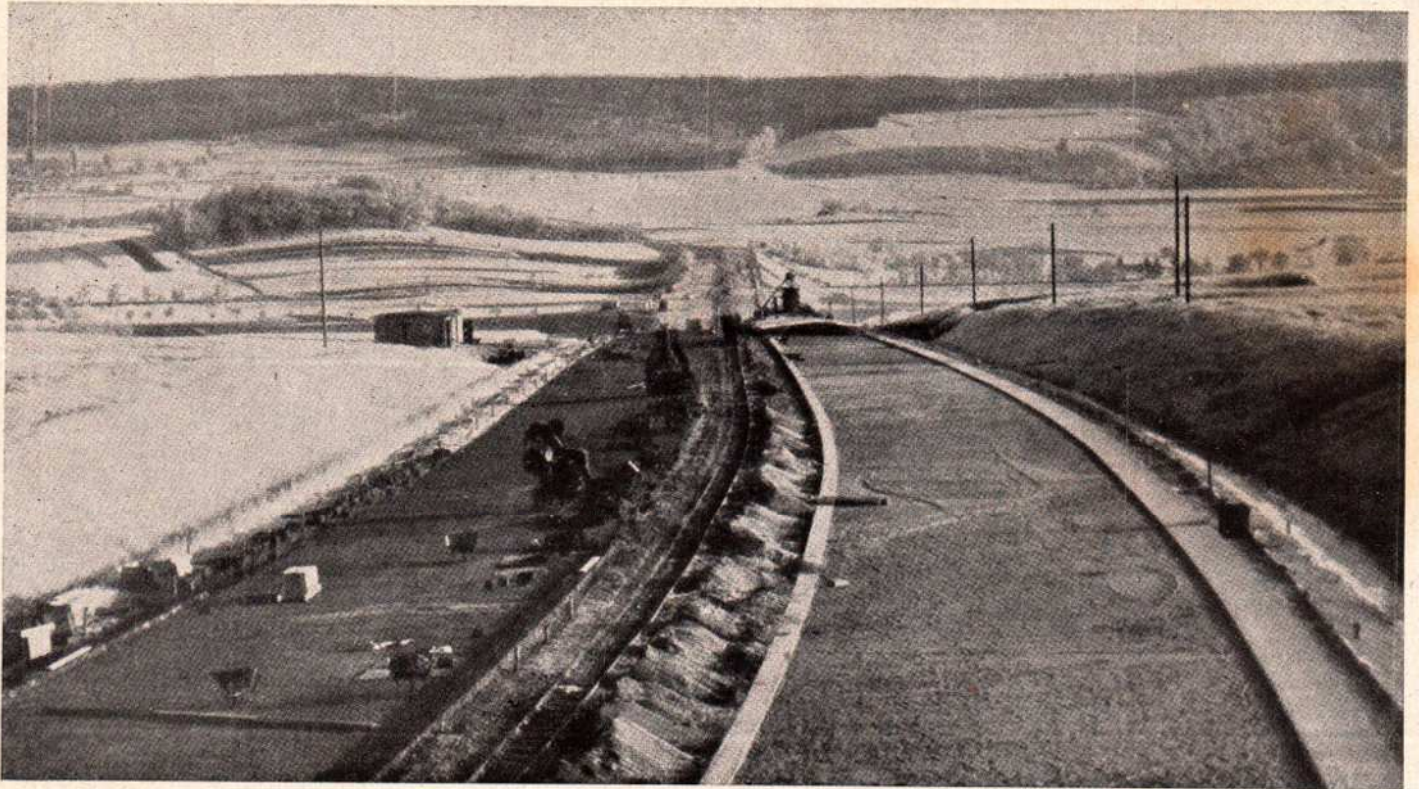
Photographia demonstrando um trecho de auto-estrada em construção. A faixa central se conserva durante todo o periodo da construção como leito para o decauville
